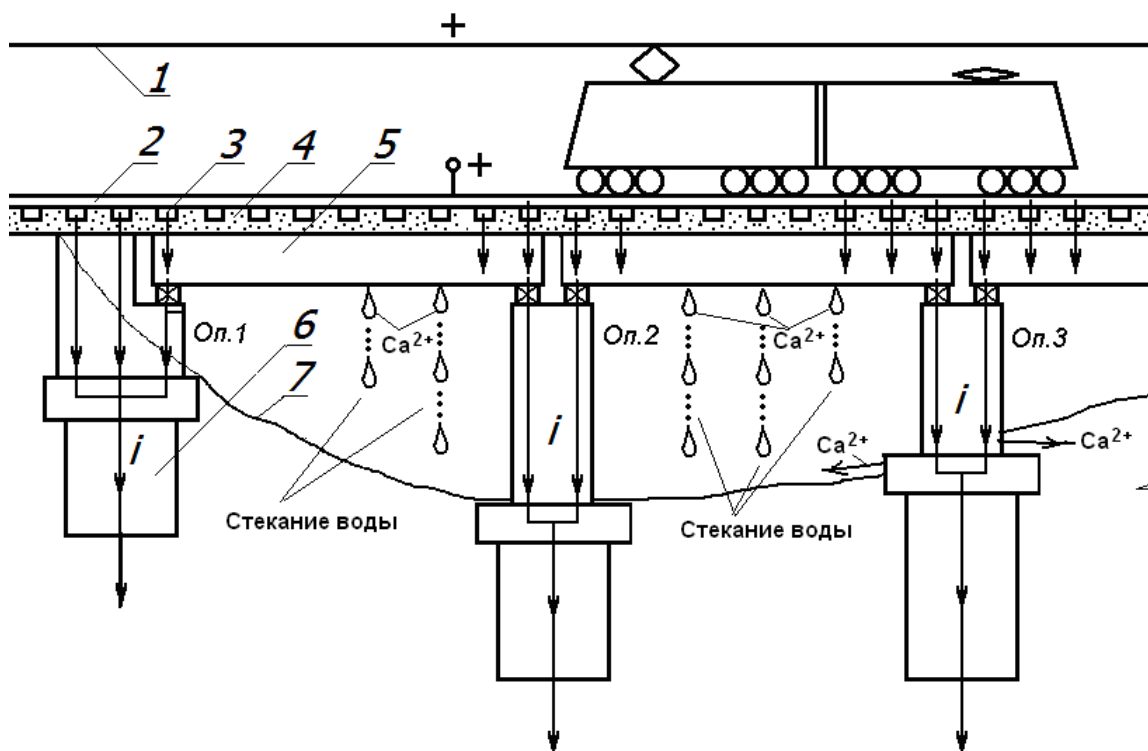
Схема протекания токов утечки по конструкциям железобетонного моста:
